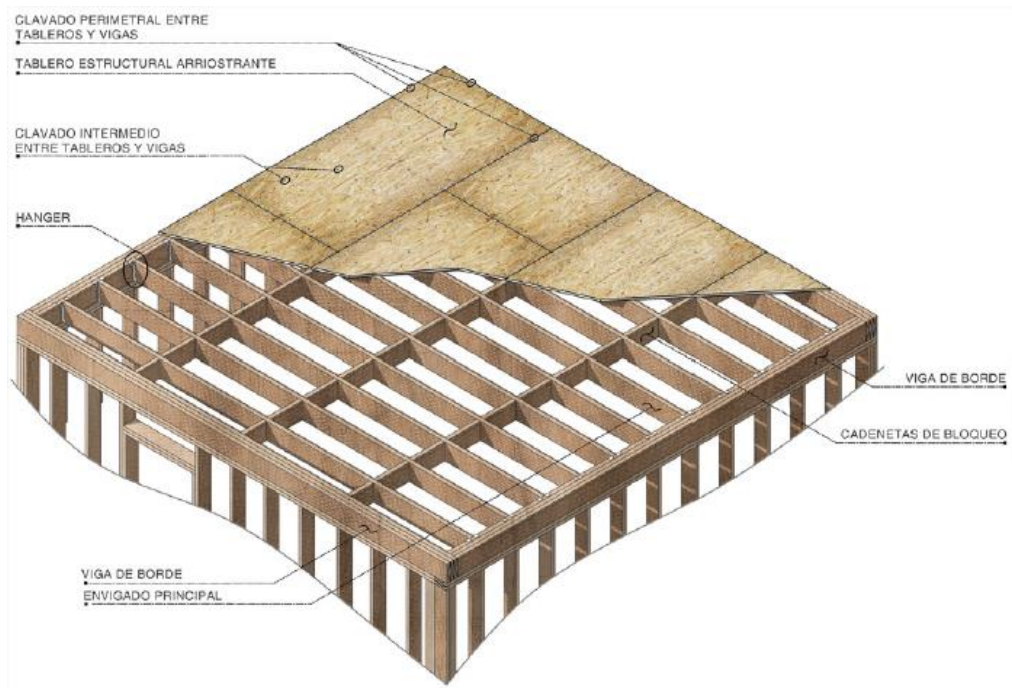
Entramado de entrepiso, fuente: Centro UC de Innovación en Madera- Chile, 2021.
